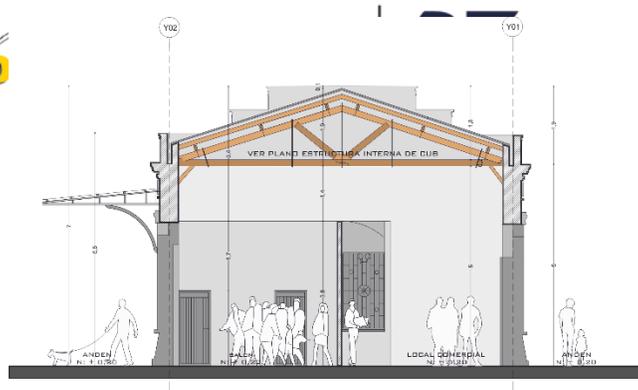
Sección transversal C-C, Estación del ferrocarril Sur.
